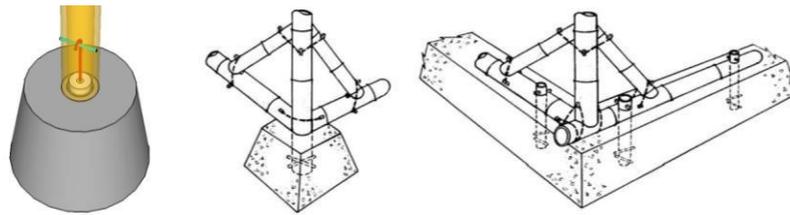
Penerapan Jumlah Bambu Pada Konstruksi
